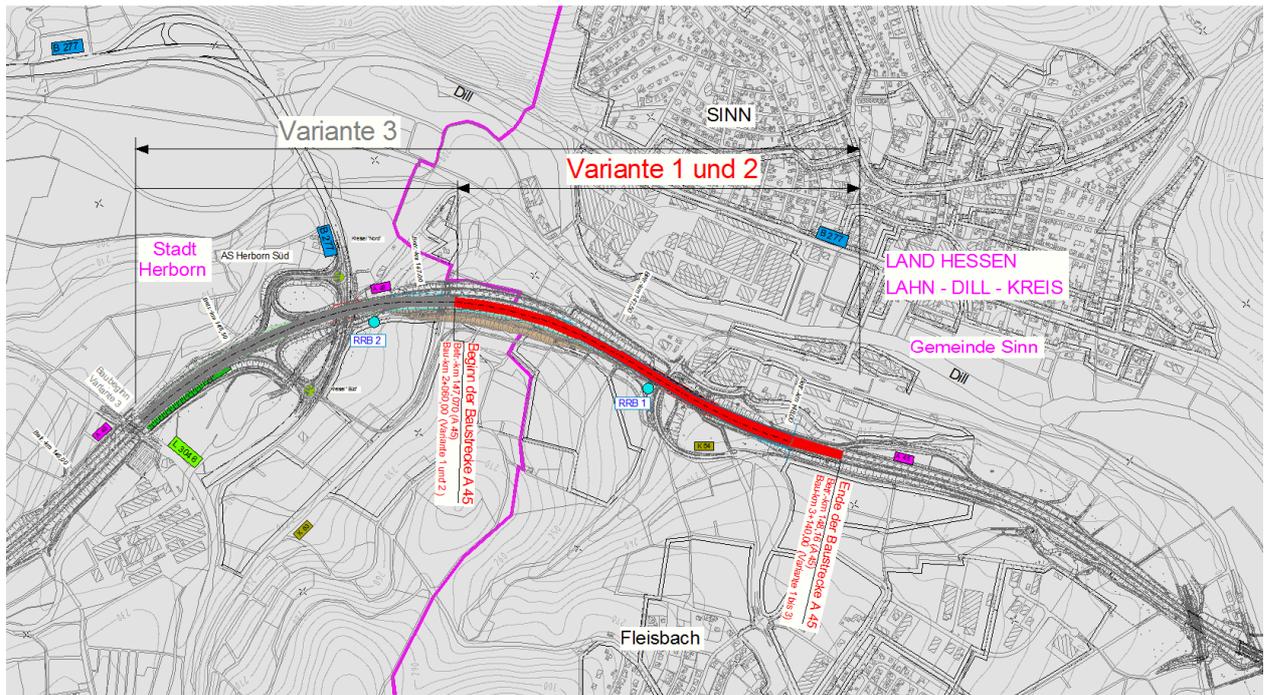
Übersichtslageplan mit Darstellung der Varianten
